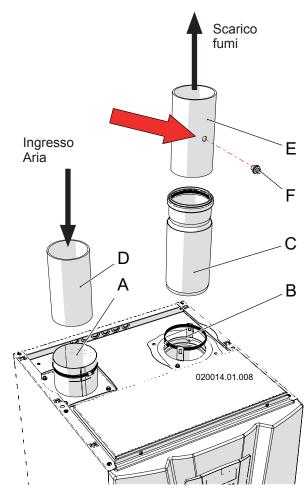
Installazione del sistema "Sdoppiato 80/80"
